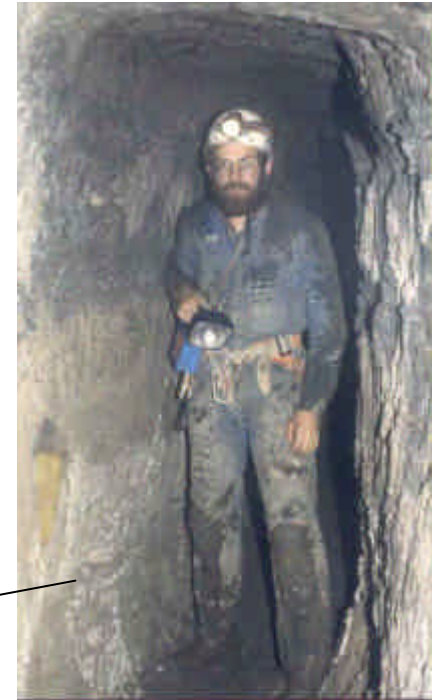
Tunnel bei Pétz 7 im Bereich der abgeschrägten Tunnelsohle
